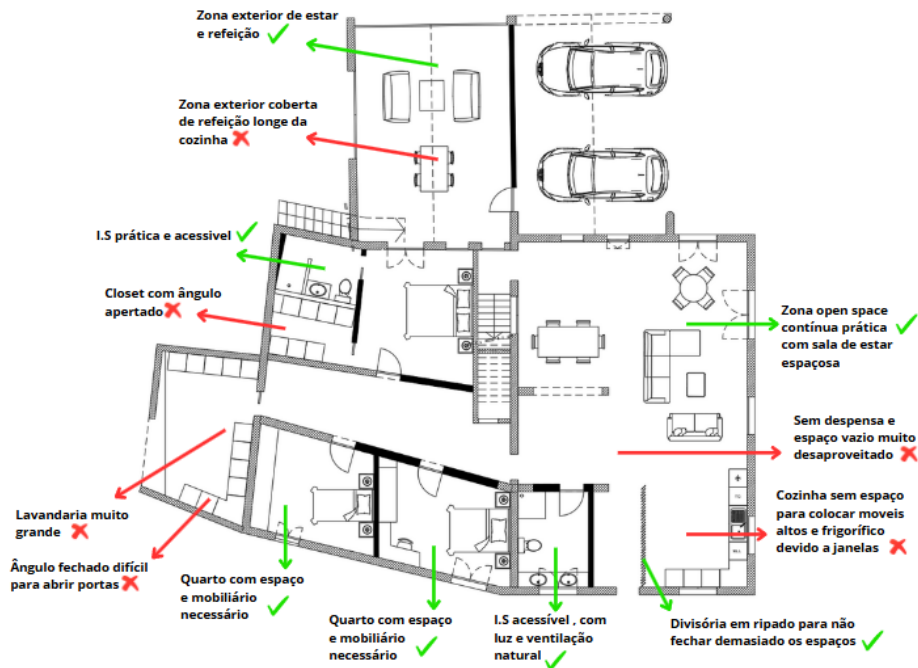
Análise de plantas esboço, proposta 7 , piso 0
